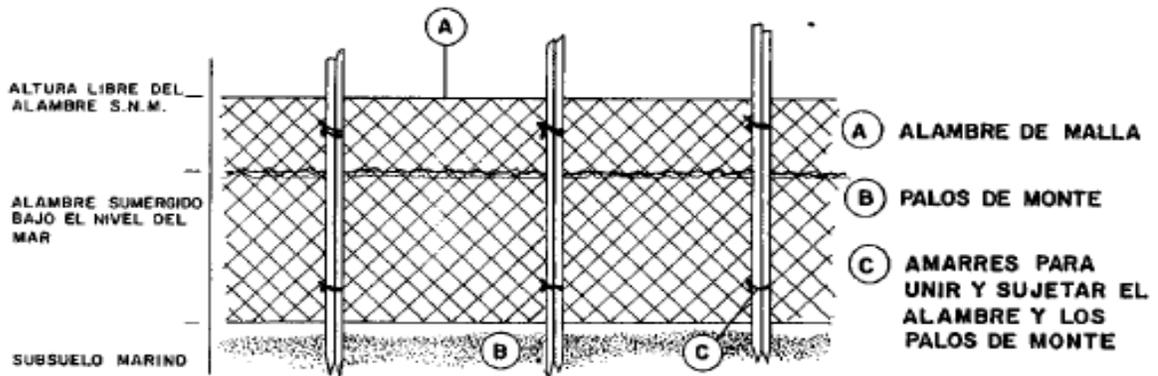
Alambre de malla colocado en las maderas de las trampas
